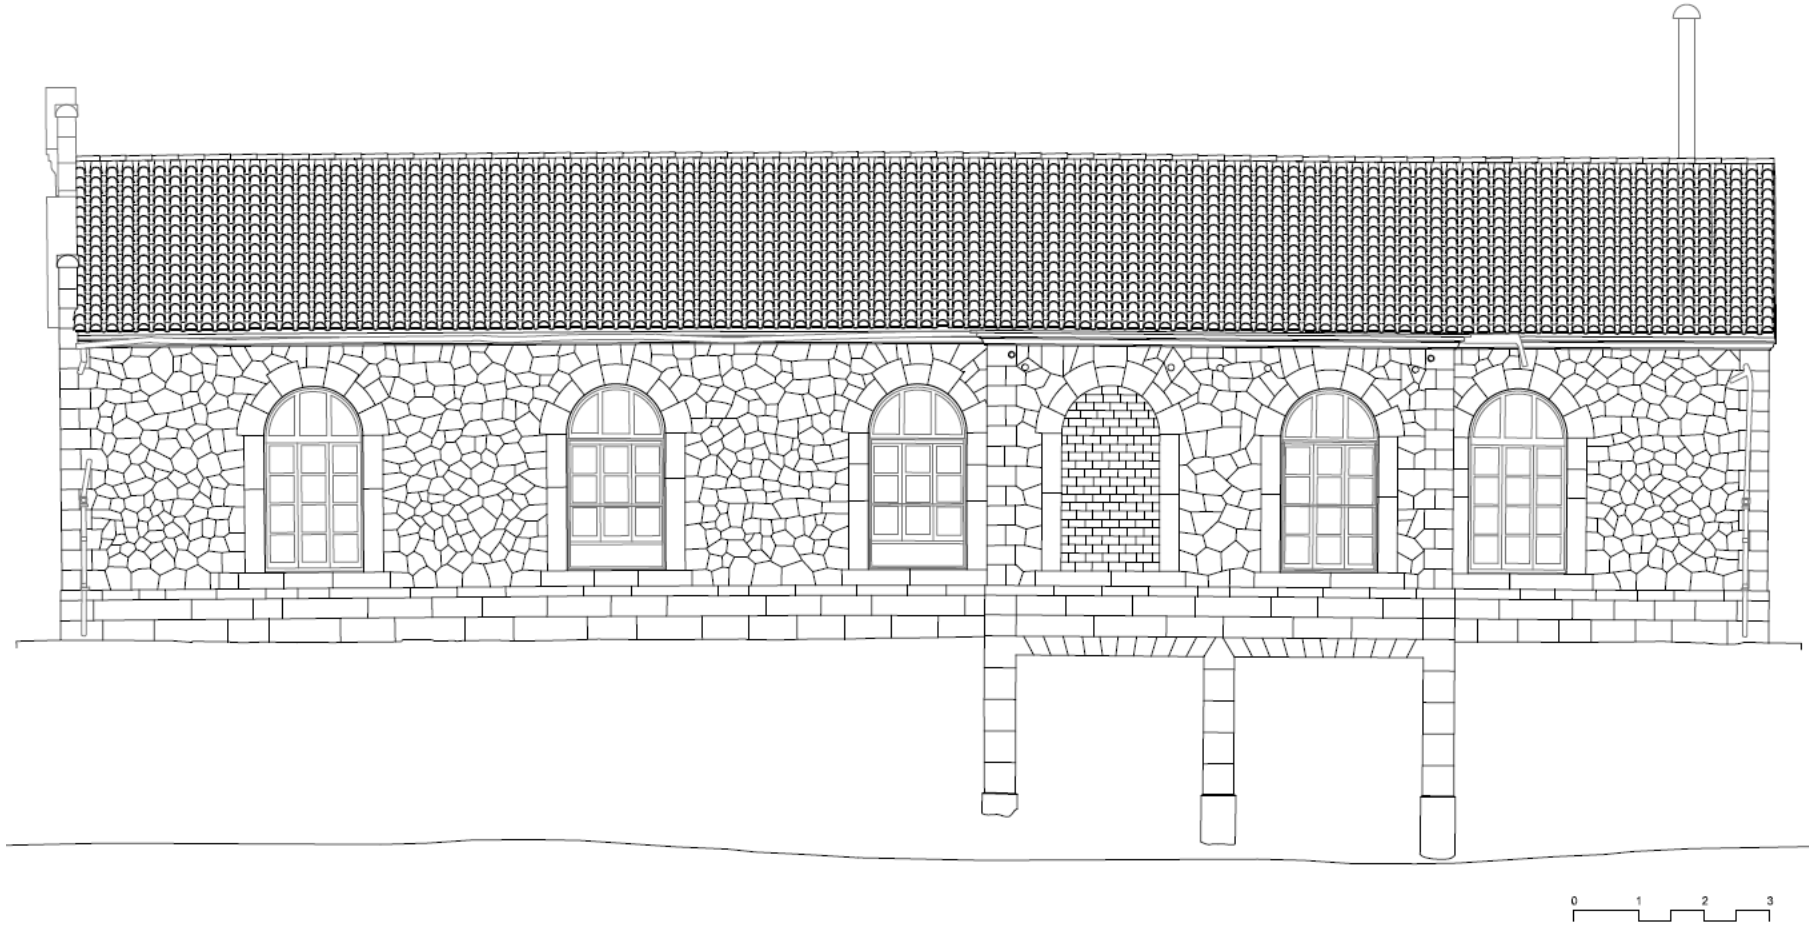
Alzado lateral Este. Levantamiento planimétrico.
